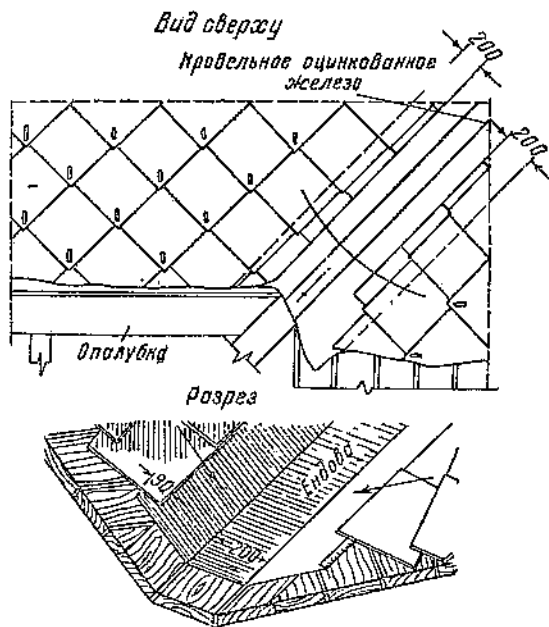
Устройство разжелобков при покрытии кровли асбестоцементными плитками.
